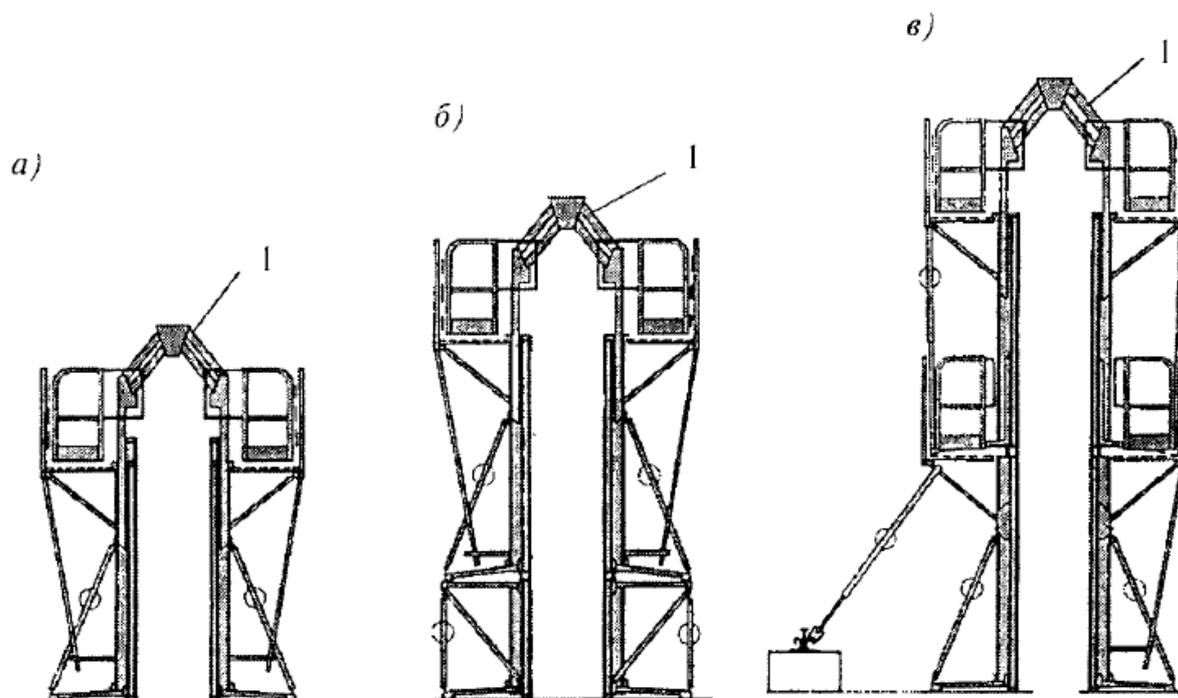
Опалубка колонн фирмы «НОЕ»:
